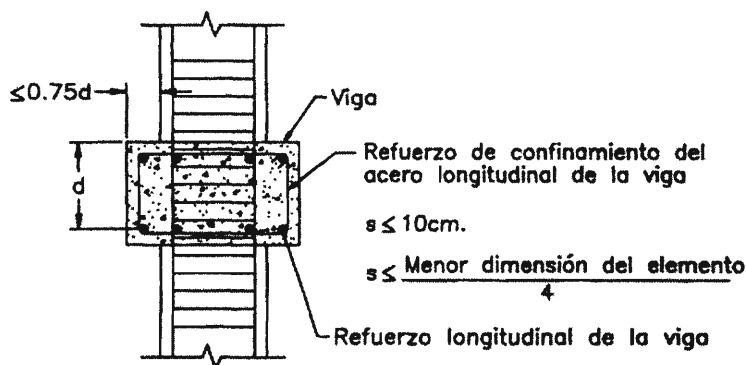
Confinamiento del refuerzo longitudinal de vigas
